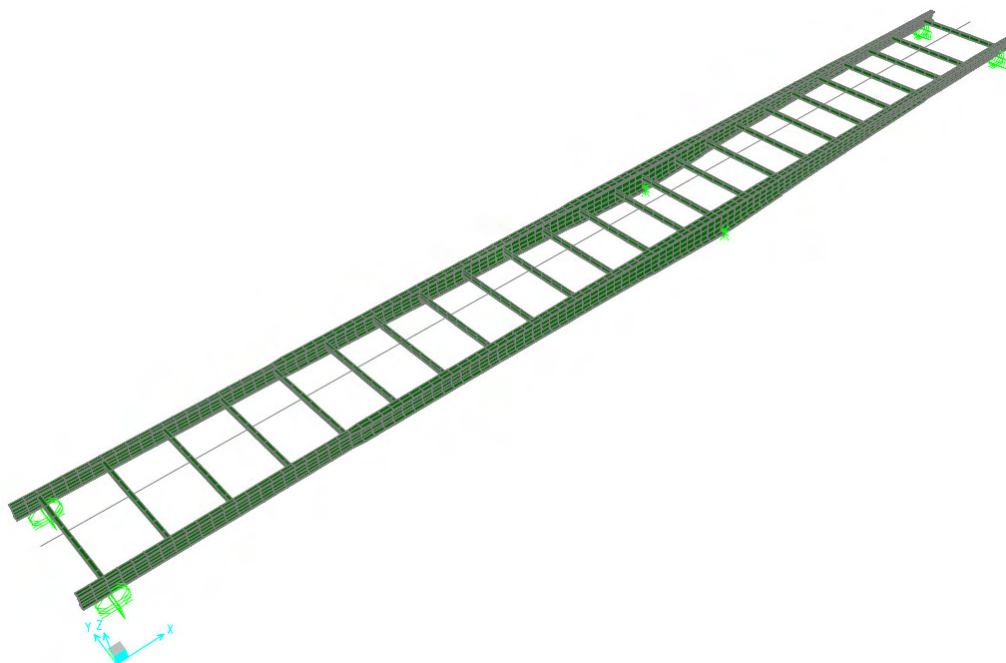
Modelo final das vigas metálicas longitudinais com os contraventamentos.
